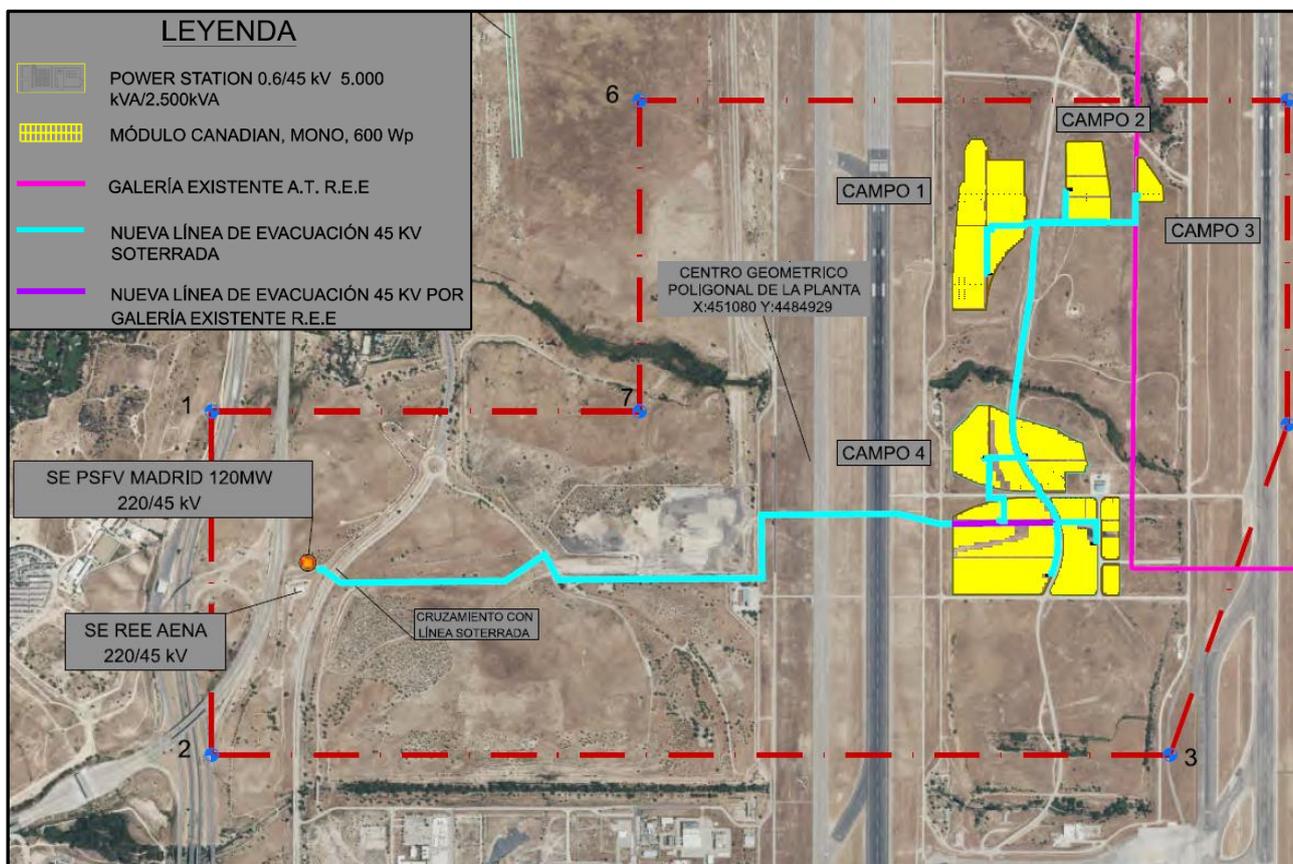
Planta general del proyecto. Fuente: plano nº 02-01-01 del EsIA presentado.
